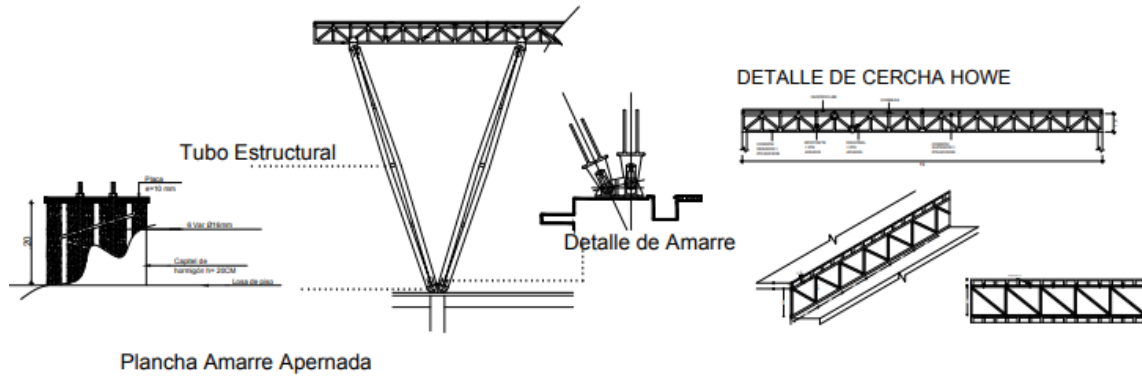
Detalles de Unión de columna y Cercha. (2019)
